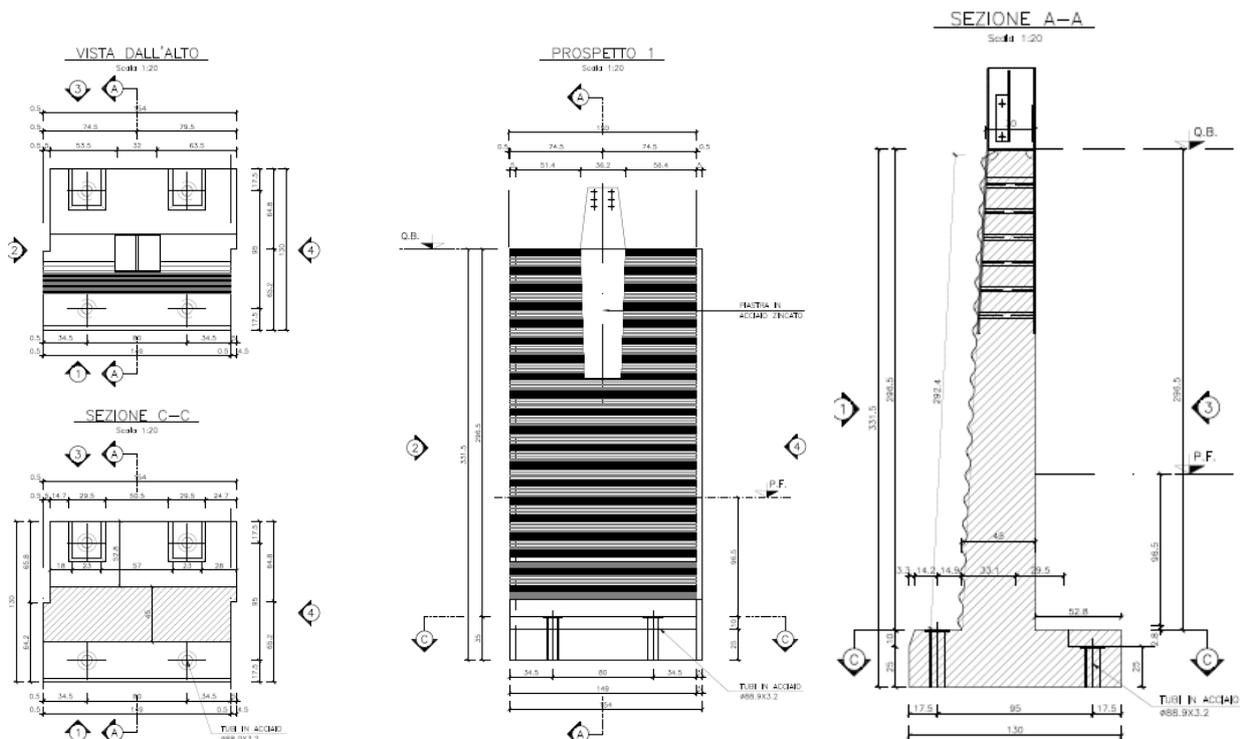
Pianta a livello fondazioni, prospetto e sezione laterale del modulo BM130
